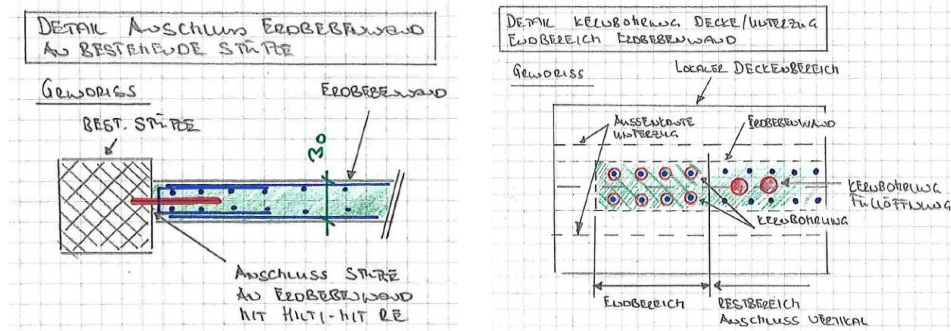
Detail zum Anschluss der Erdbebenwand an die bestehende Tragstruktur
